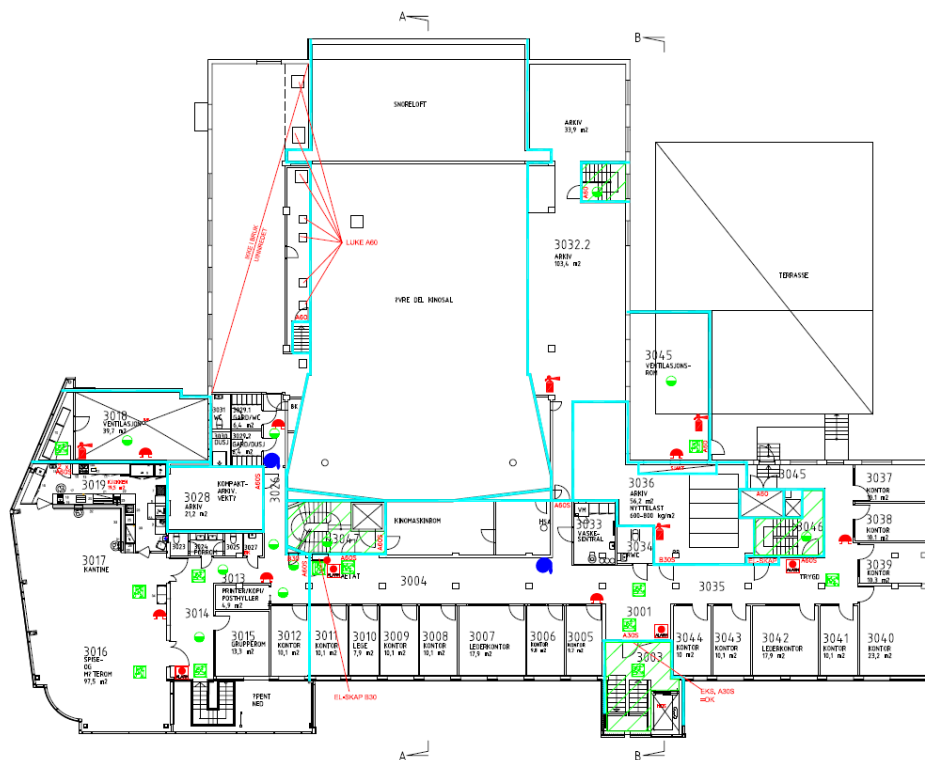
Ny situasjon plan 1. etasje (fase 1).
